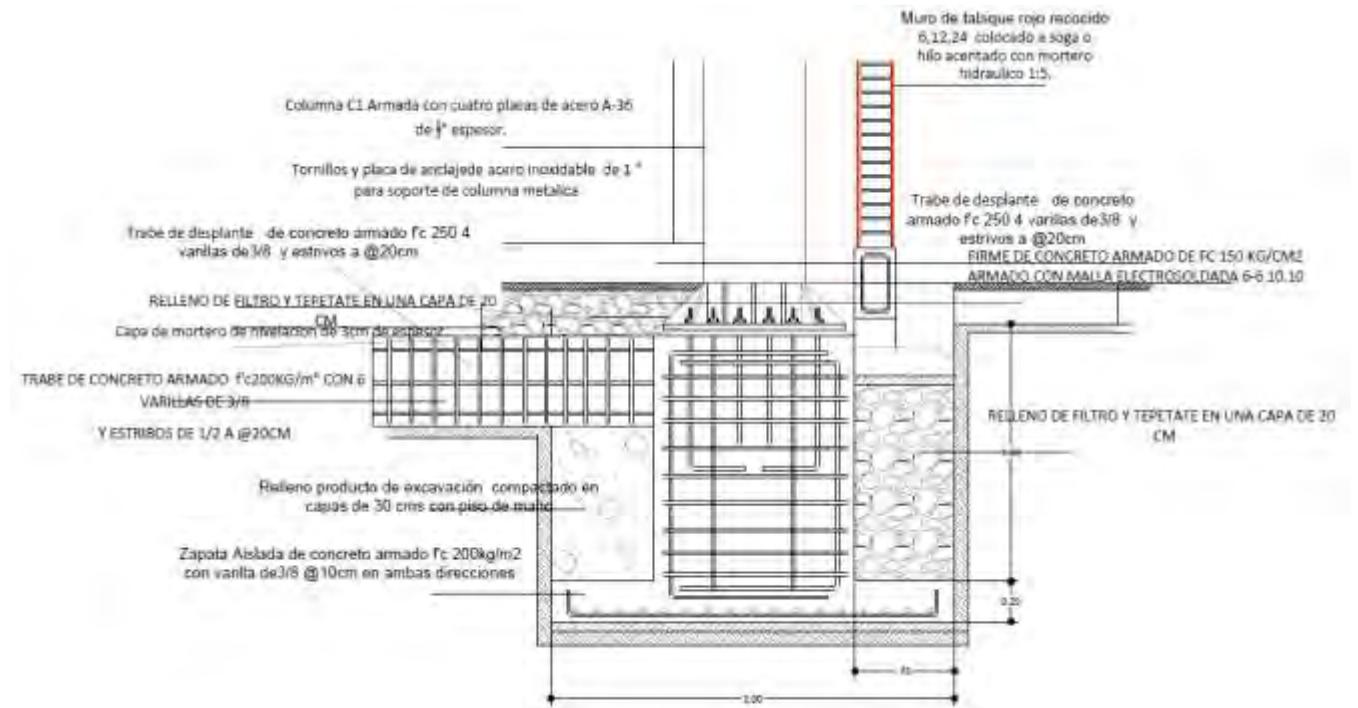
Esquema gráfico de una Zapata aislada de concreto armado. Trazo por: autor de esta tesis.
